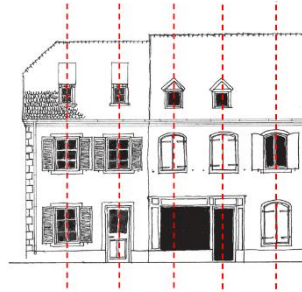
Exemple d'ordonnement d'une façade et d'une devanture en applique (illustration sans valeur réglementaire)
